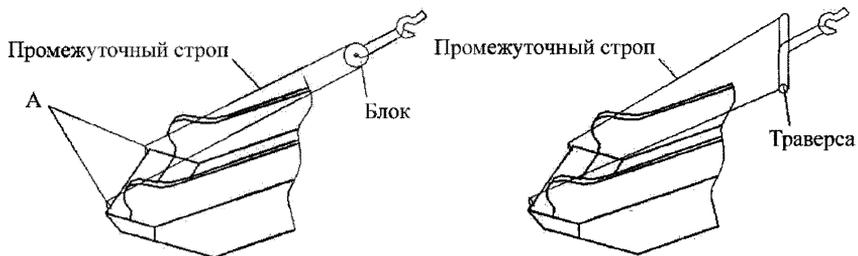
Схемы строповки эскалатора за грузовые скобы
